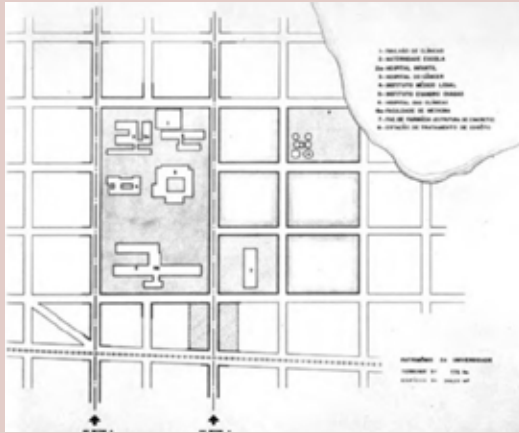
Plano Urbanístico do Campus do Porangabuçu.
